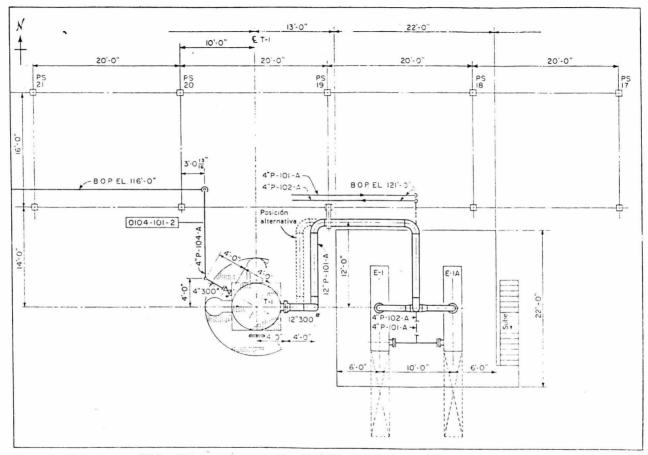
DIBUJO DE PLANTA Y SECCION DE TUBERIAS.
